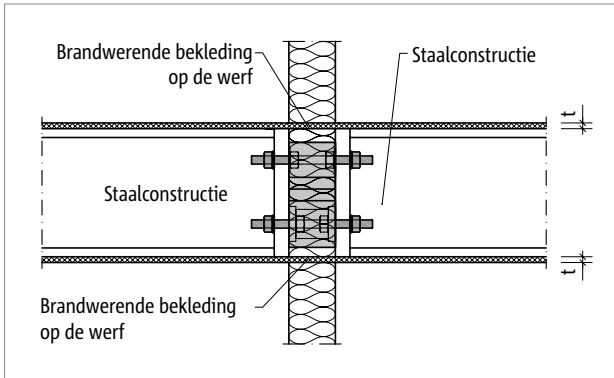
Schöck Isokorb® type SQ: op de werf aangebrachte brandwerende bekleding, type SQ en staalconstructie met brandwerende coating; doorsnede
